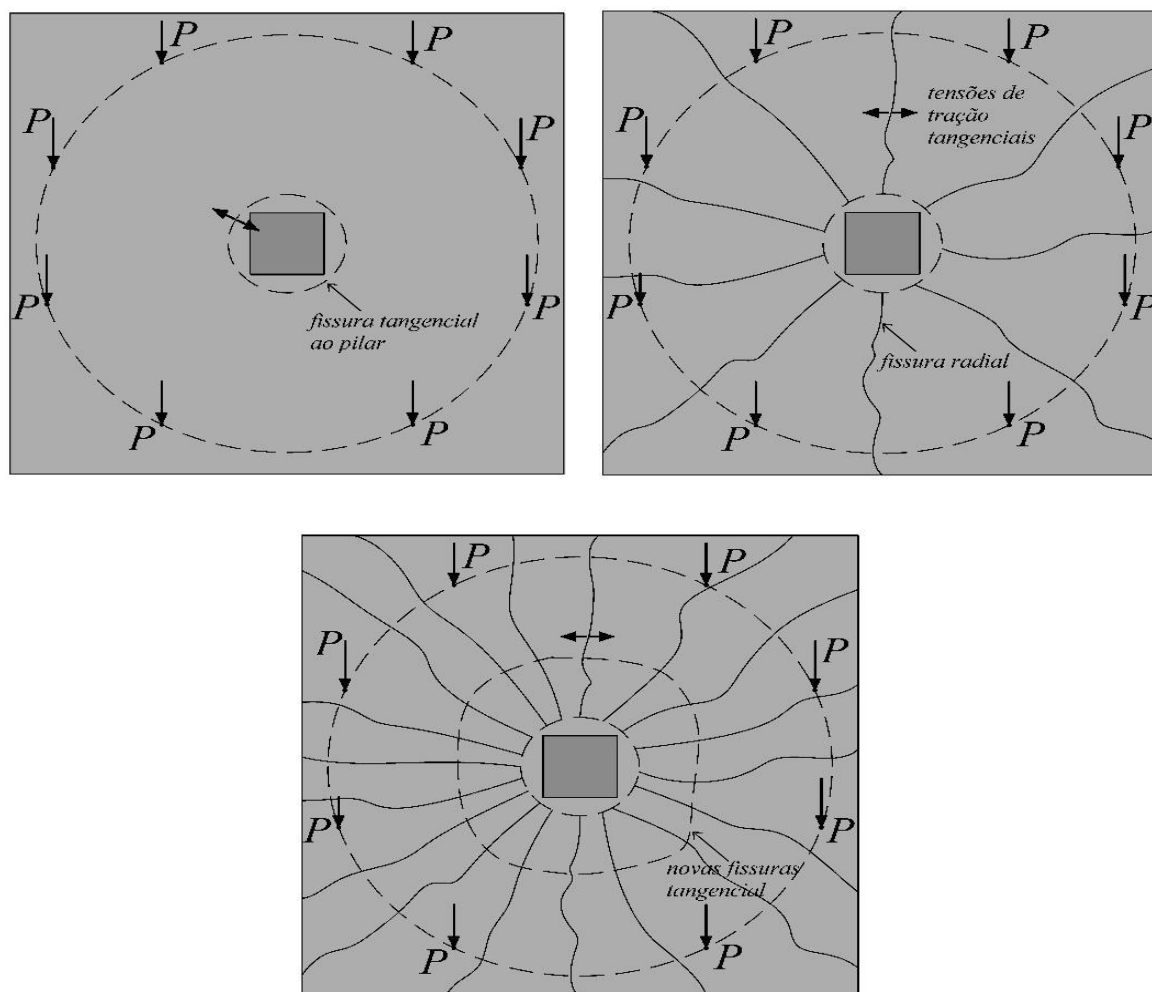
Processo de formação de fissuras de punção. 1) fissura tangencial formada por tensões radiais; 2) fissuras radiais formadas por tensões tangenciais; 3) estágio final de ruptura à punção de laje lisa.
